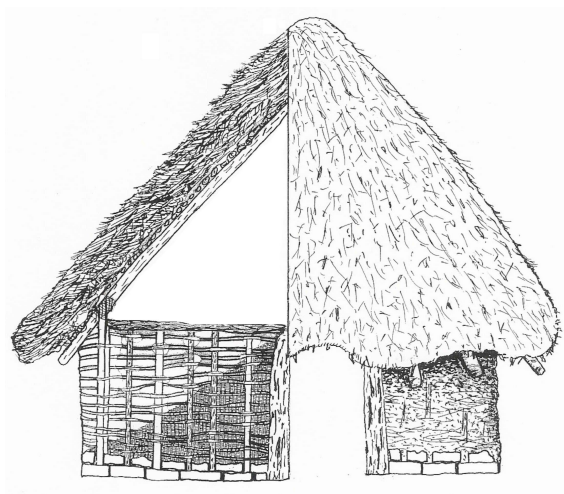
Reconstrucción del esquema de vivienda castreña del siglo IV d.C. hallada en la Garba.
